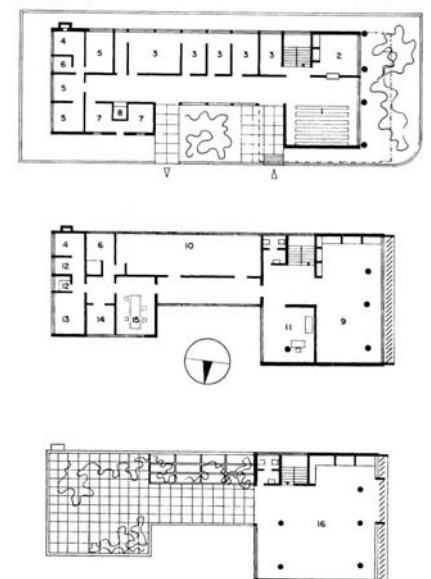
Obra do Berço, Rio de Janeiro, 1937. Oscar Niemeyer. Plantas térreo, superior e segundo pavimento.
